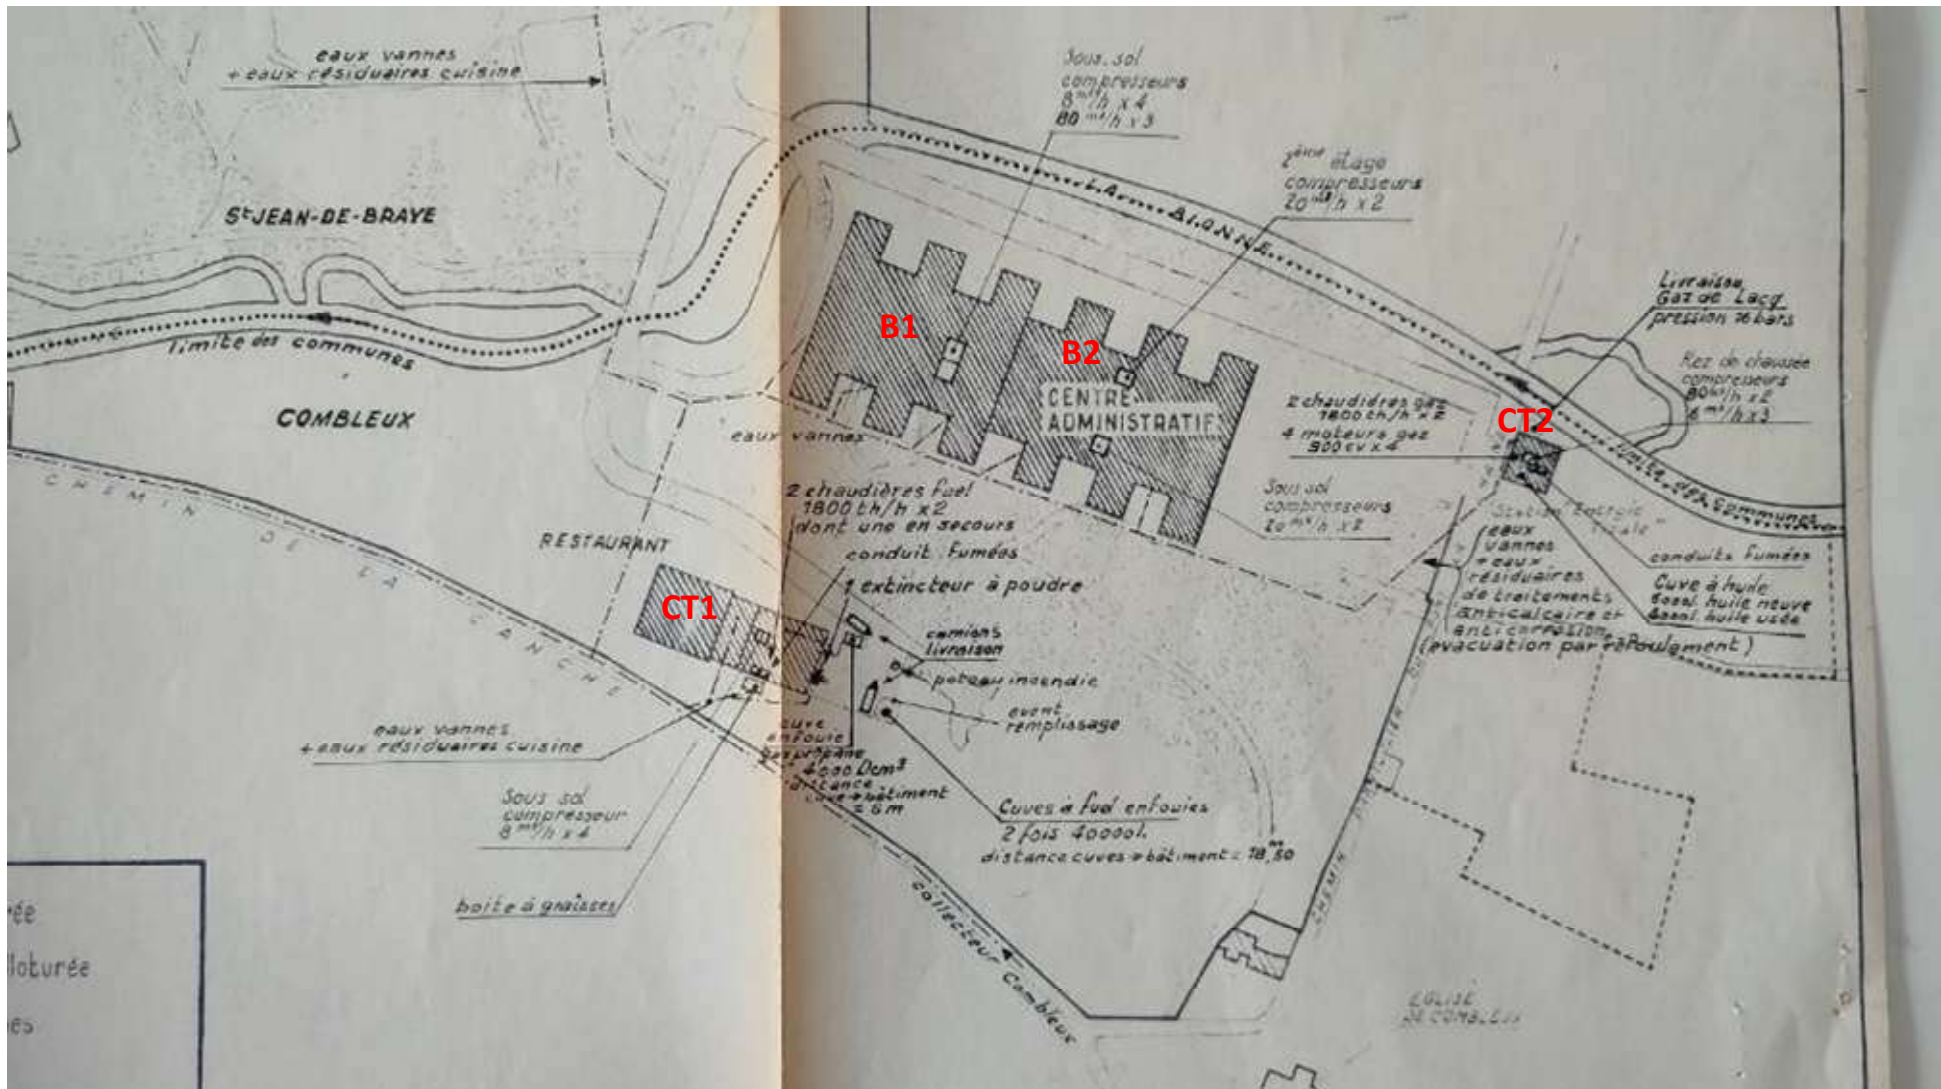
Plan détaillé des installations du site (Préfecture du Loiret, 5 février 1975)
